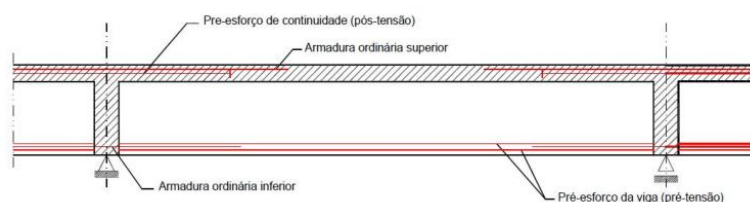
Pré-esforço aplicado na laje sobre os apoios (Sousa, 2004)
